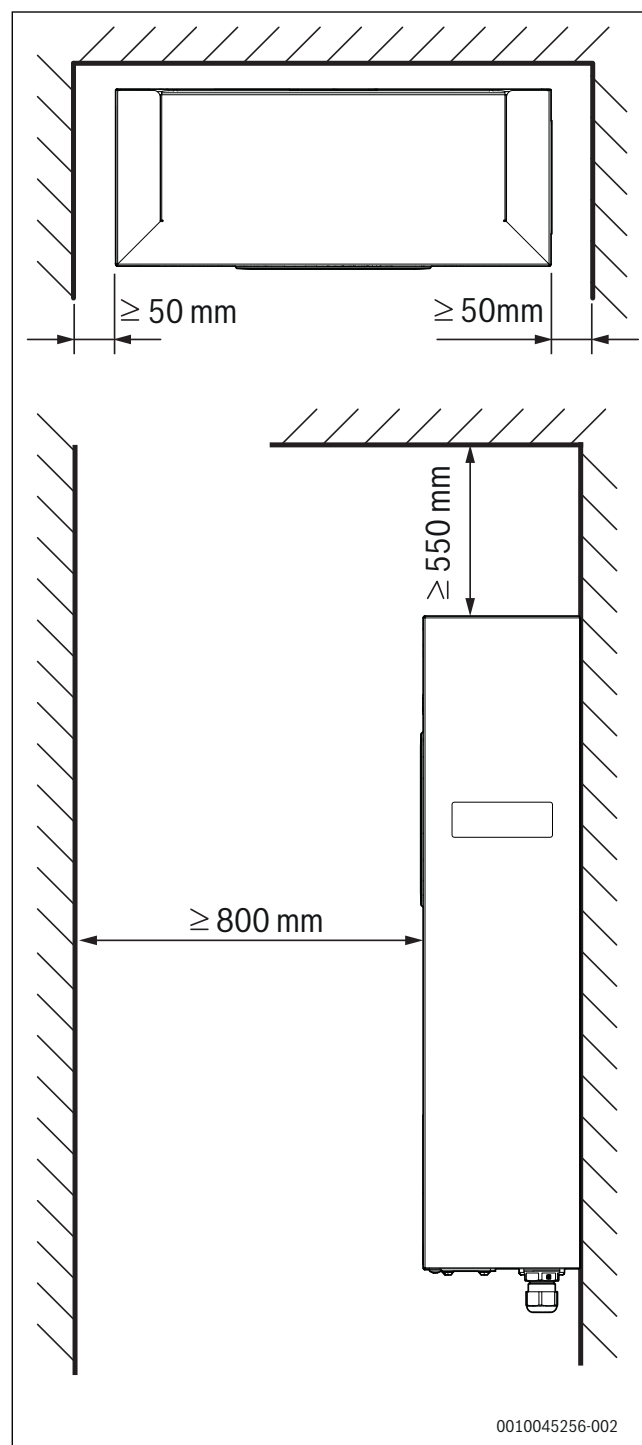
Mindestabstände zu Wänden und anderen Gegenständen (mm)
